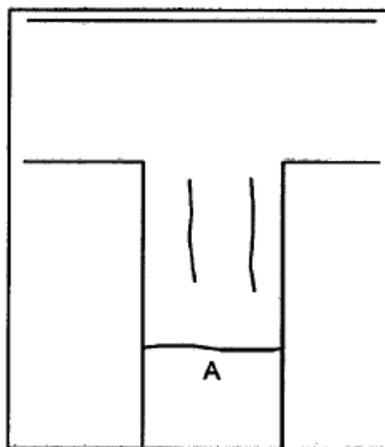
Fisuras por retracción plástica en cabeza de columnas
